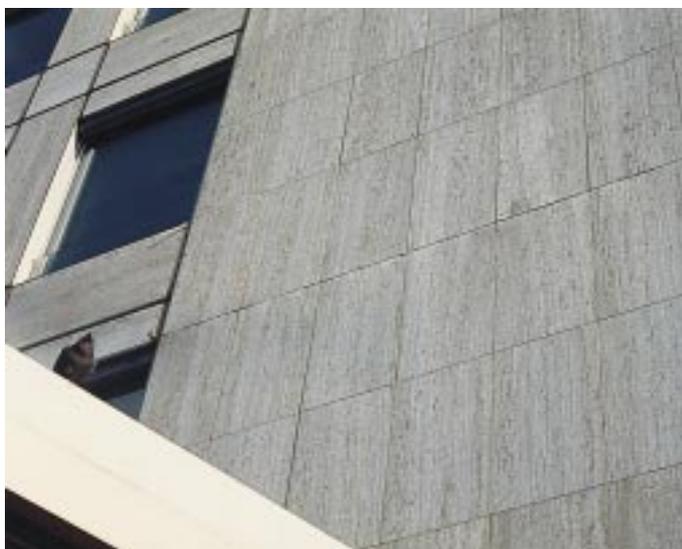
An Außenwänden im Hochbau sind zwischen Bauteilen aus unverputztem Mauerwerk und Ortbeton Bewegungsfugen konstruktiv entsprechend DIN 18 540 einzuplanen und mit Dichtstoff fachgerecht zu schließen
